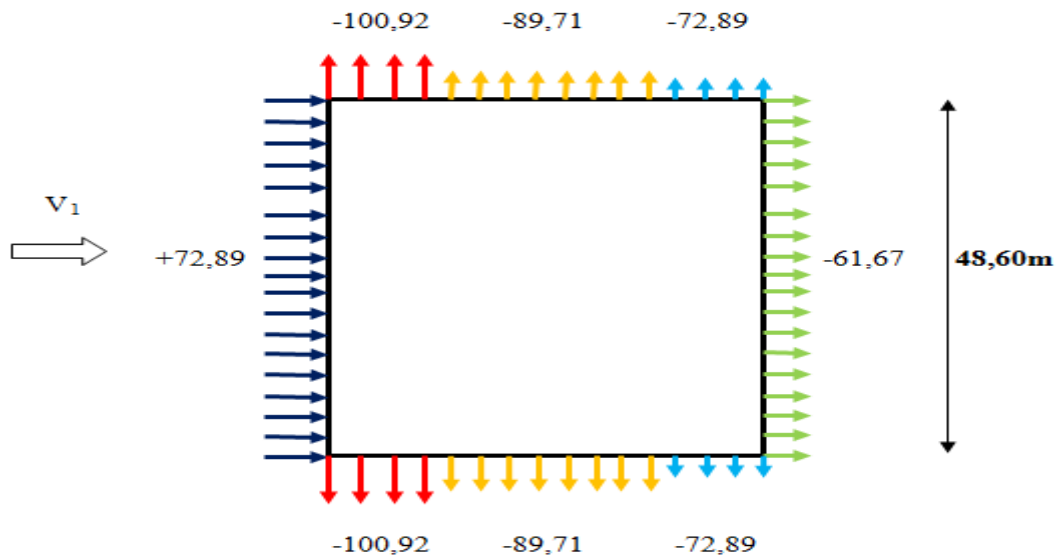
Pressions sur les parois verticales suivant long-pan (Niveau 2)
